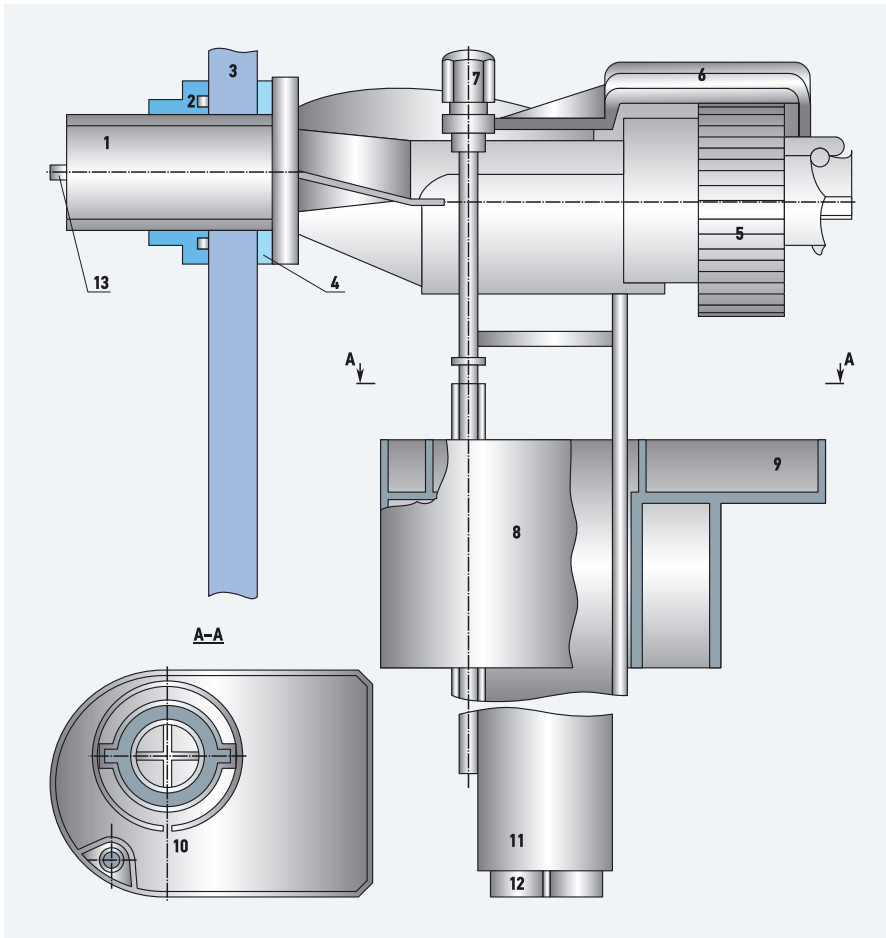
Конструктивная схема наполнительной арматуры с сервоуправлением с боковой подводкой фирмы AlcaPlast (1 — корпус арматуры; 2 — крепежная гайка; 3 — боковая стенка смывного бачка; 4 — уплотнительная прокладка; 5 — накидная гайка; 6 — рычаг; 7 — винт регулировочный; 8 — поплавок; 9 — емкость для нагружения поплавка водой; 10 — дренажная щель; 11 — сливная труба; 12 — устройство, гасящее энергию потока; 13 — щелевой поверхностный фильтр)
